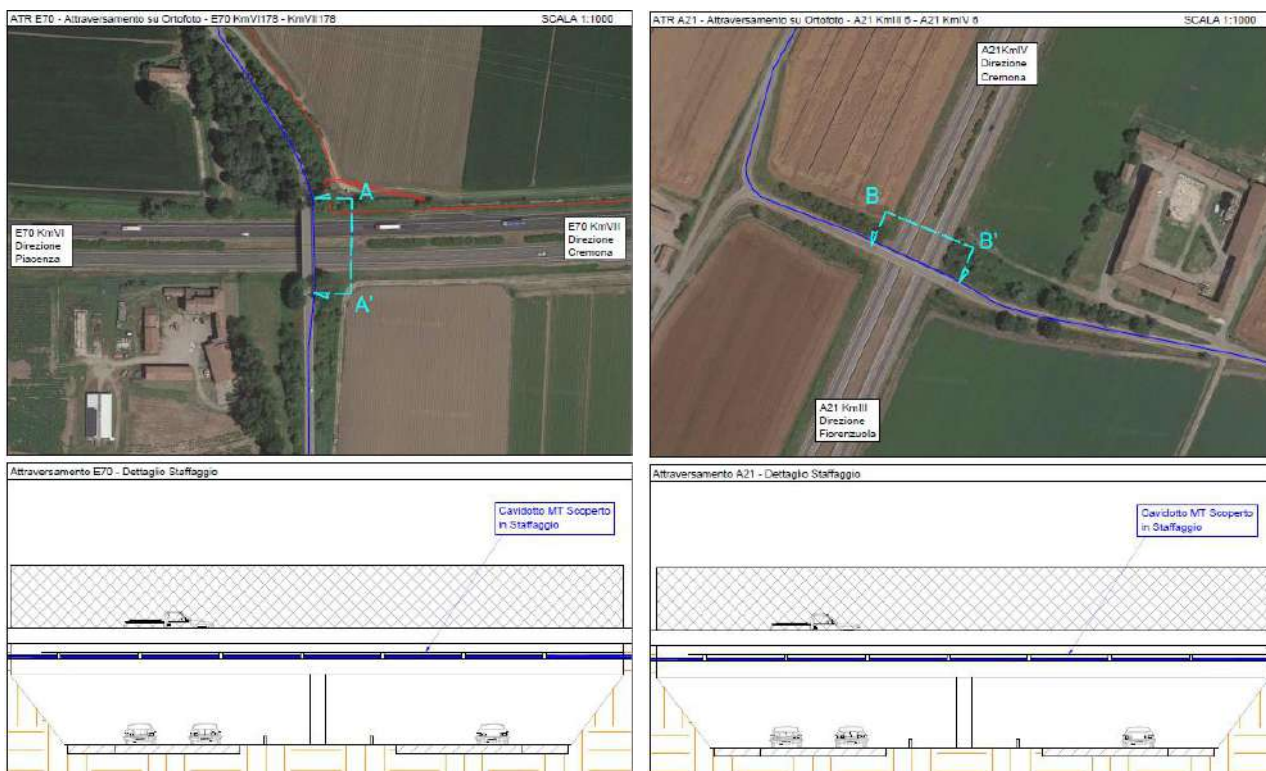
Attraversamenti tratti autostradali con staffaggio del cavidotto
